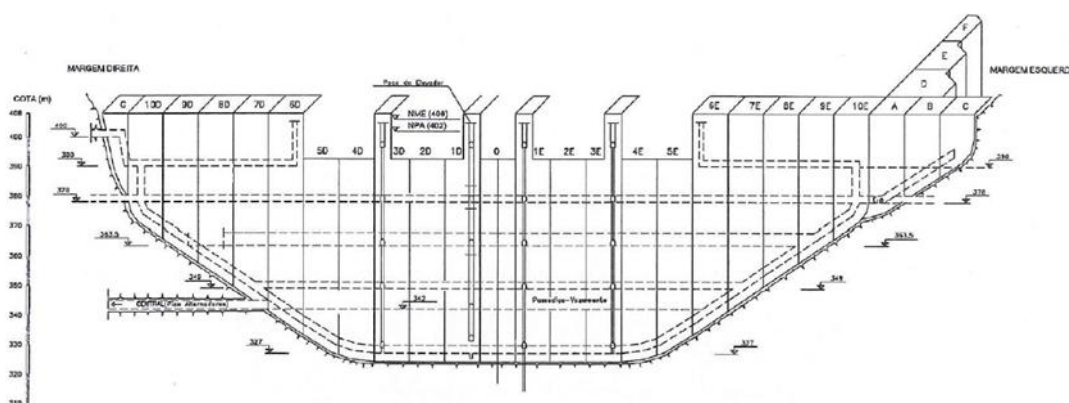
Alçado planificado (esquemático) de jusante da barragem da Bemposta (adaptado de LNEC, 2020).
